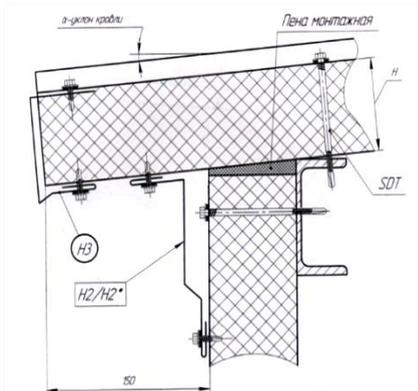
Карнизный узел при наружном неорганизованном водоотводе с покрытия
